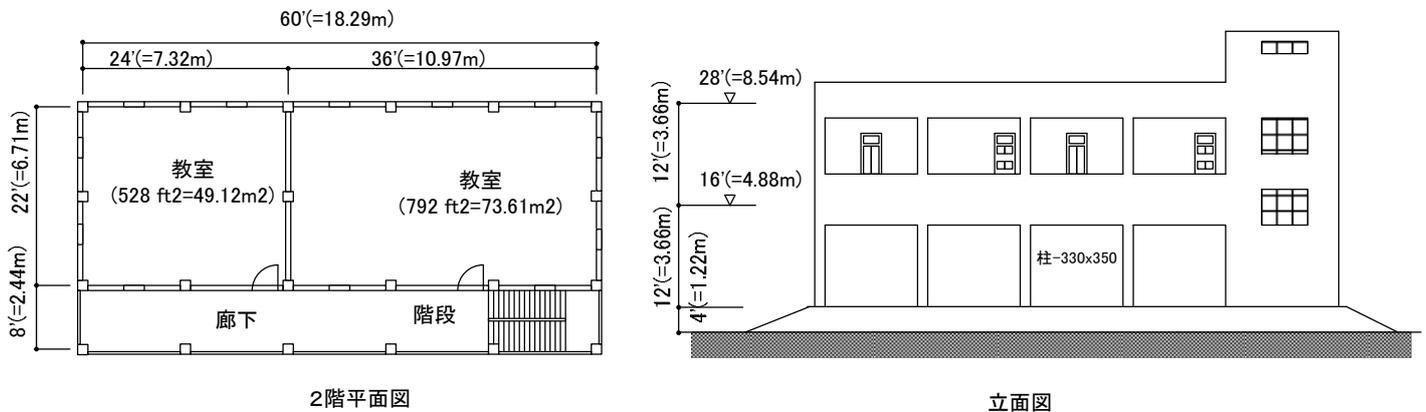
METTA FOUNDATION のサイクロンシェルター計画 (例)
